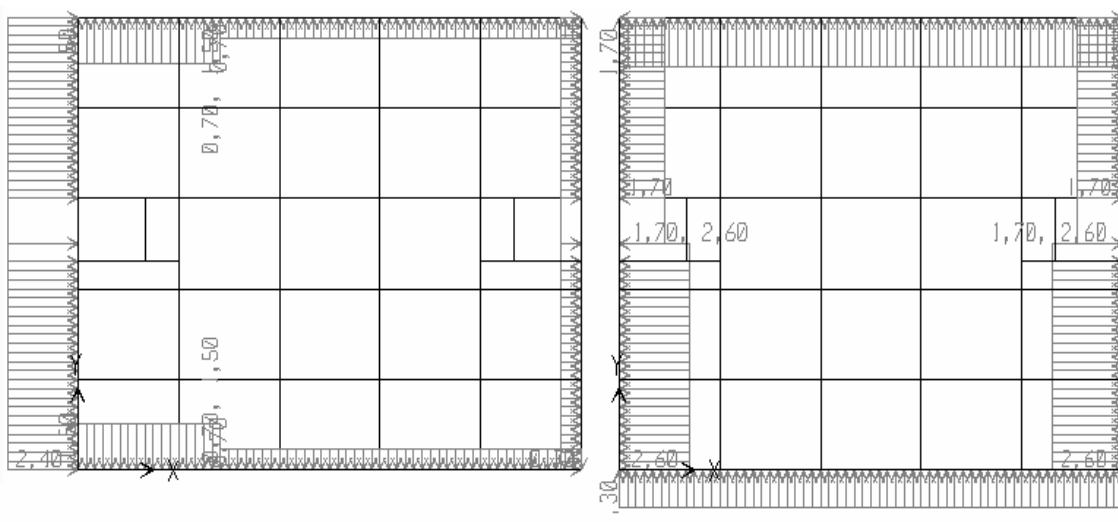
Carregamento de vento no 10º pavimento nas direções x e y.
